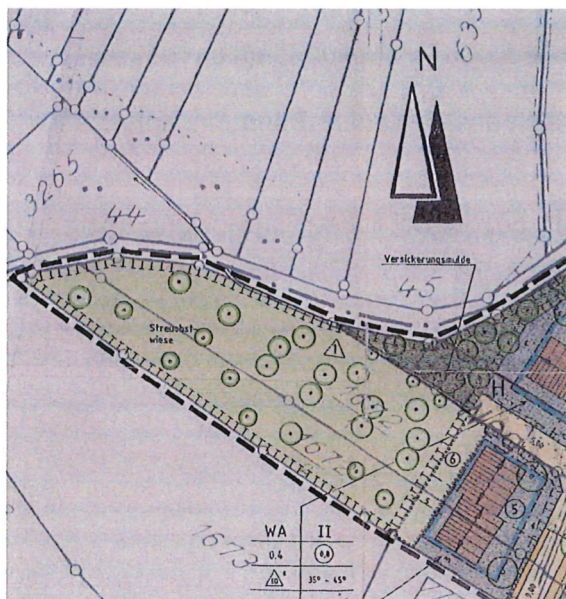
Planausschnitt Bebauungsplan "Rötél II" 1996
